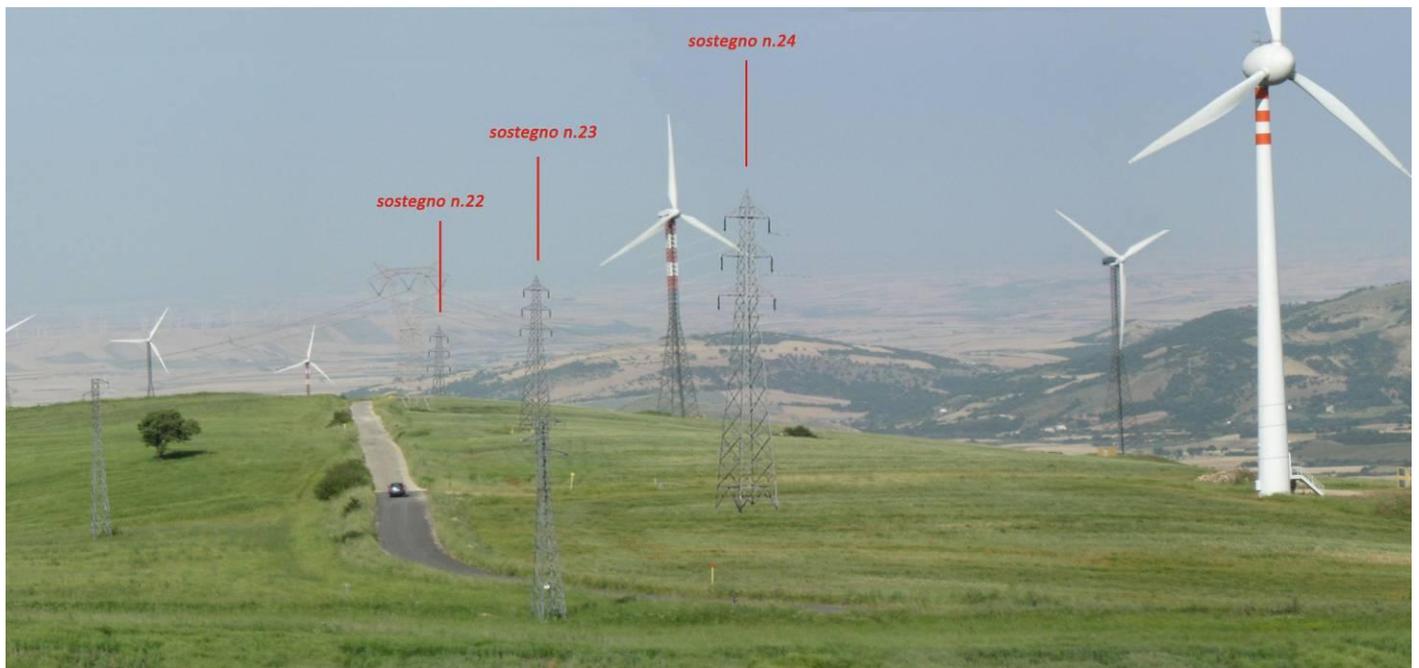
In corrispondenza dei sostegni 22,23 e 24 il tracciato corre parallelo ad una strada esistente e si raccorda ad essa con brevi tratti di pista in aree pianeggianti
